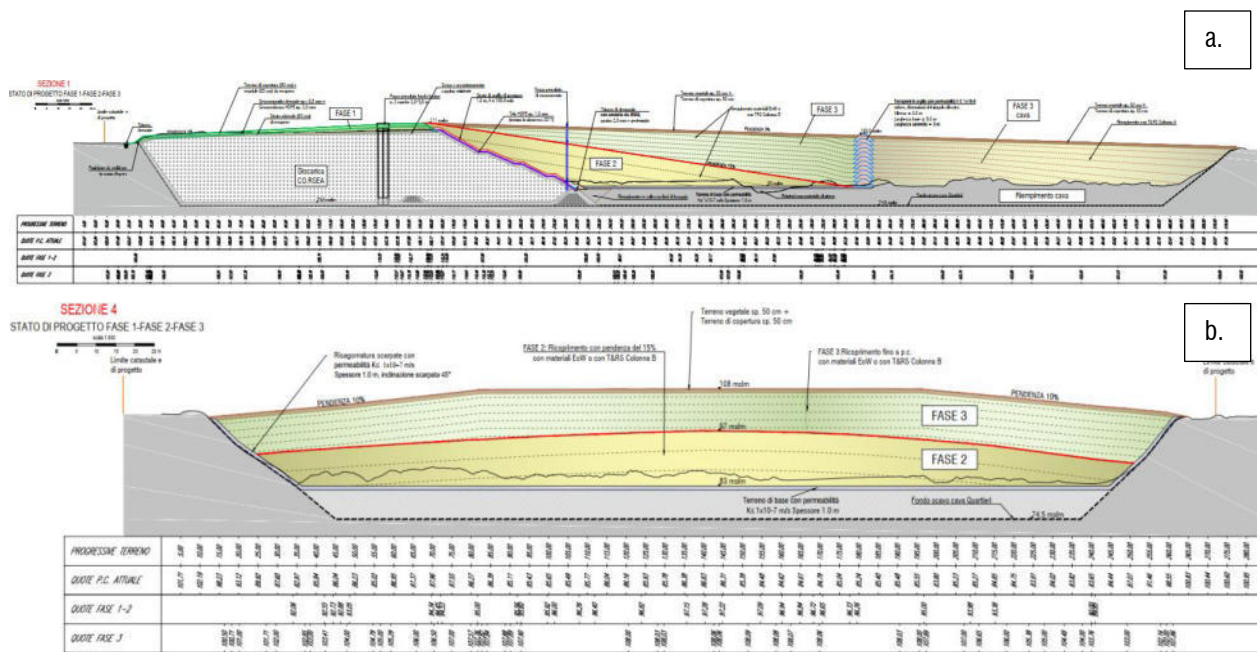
a. Estratto Sezione longitudinale n.1 con indicazione delle fasi di avanzamento; b. Estratto Sezione trasversale n.4 con indicazione delle fasi di avanzamento
